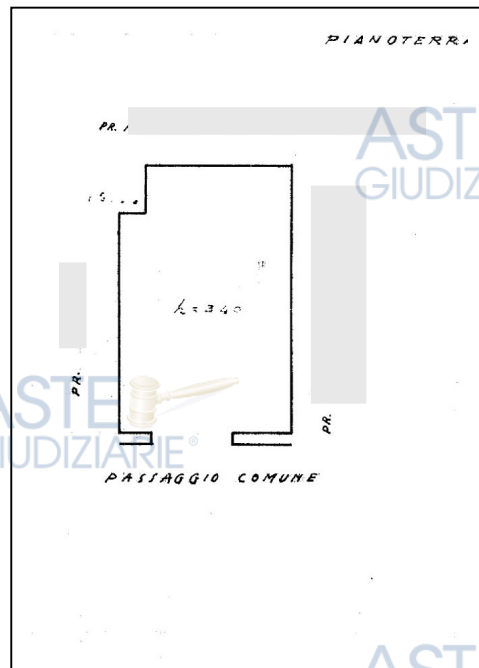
Estratto planimetria catastale di impianto del 03/05/1957
